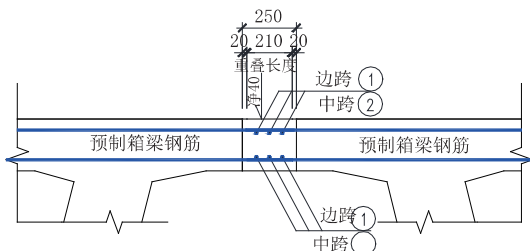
UHPC 湿接缝钢筋断面图(单位:cm)
